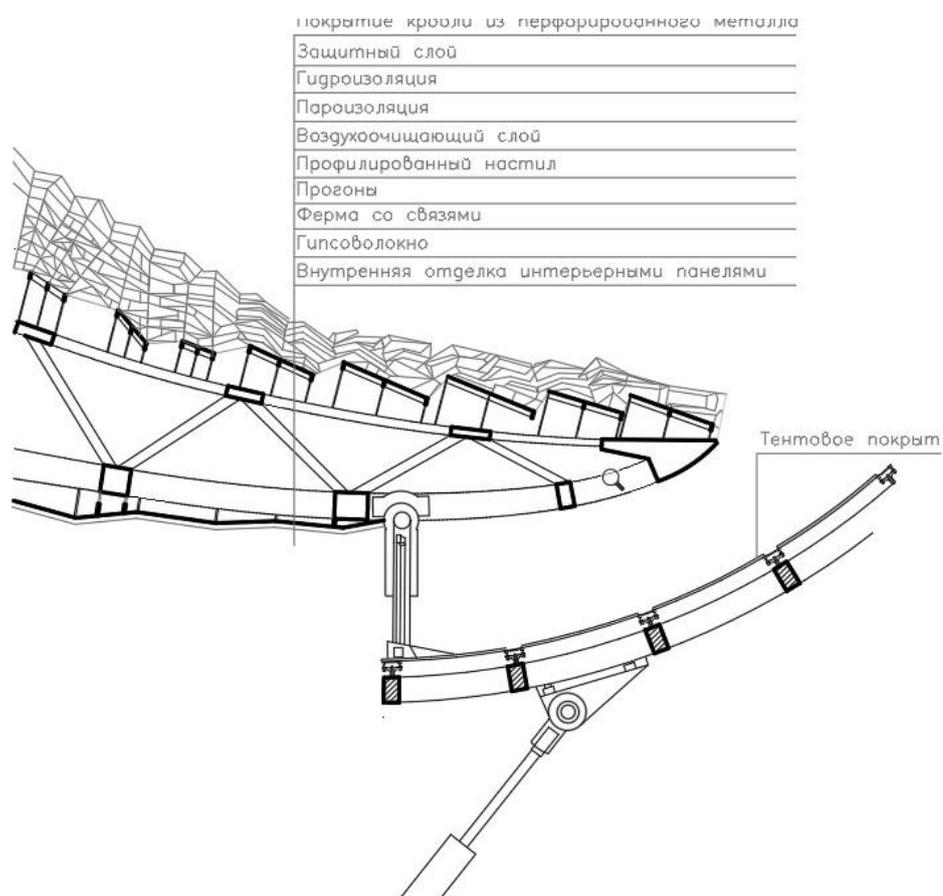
Узел примыкания кровли с тентовой кровлей внутреннего сада.
